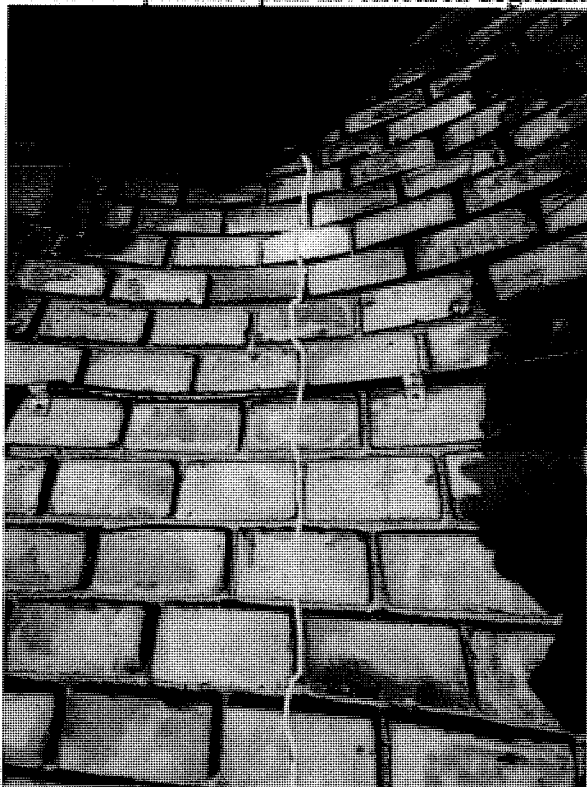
Fisuri verticale zidărie zona scării acces turn
